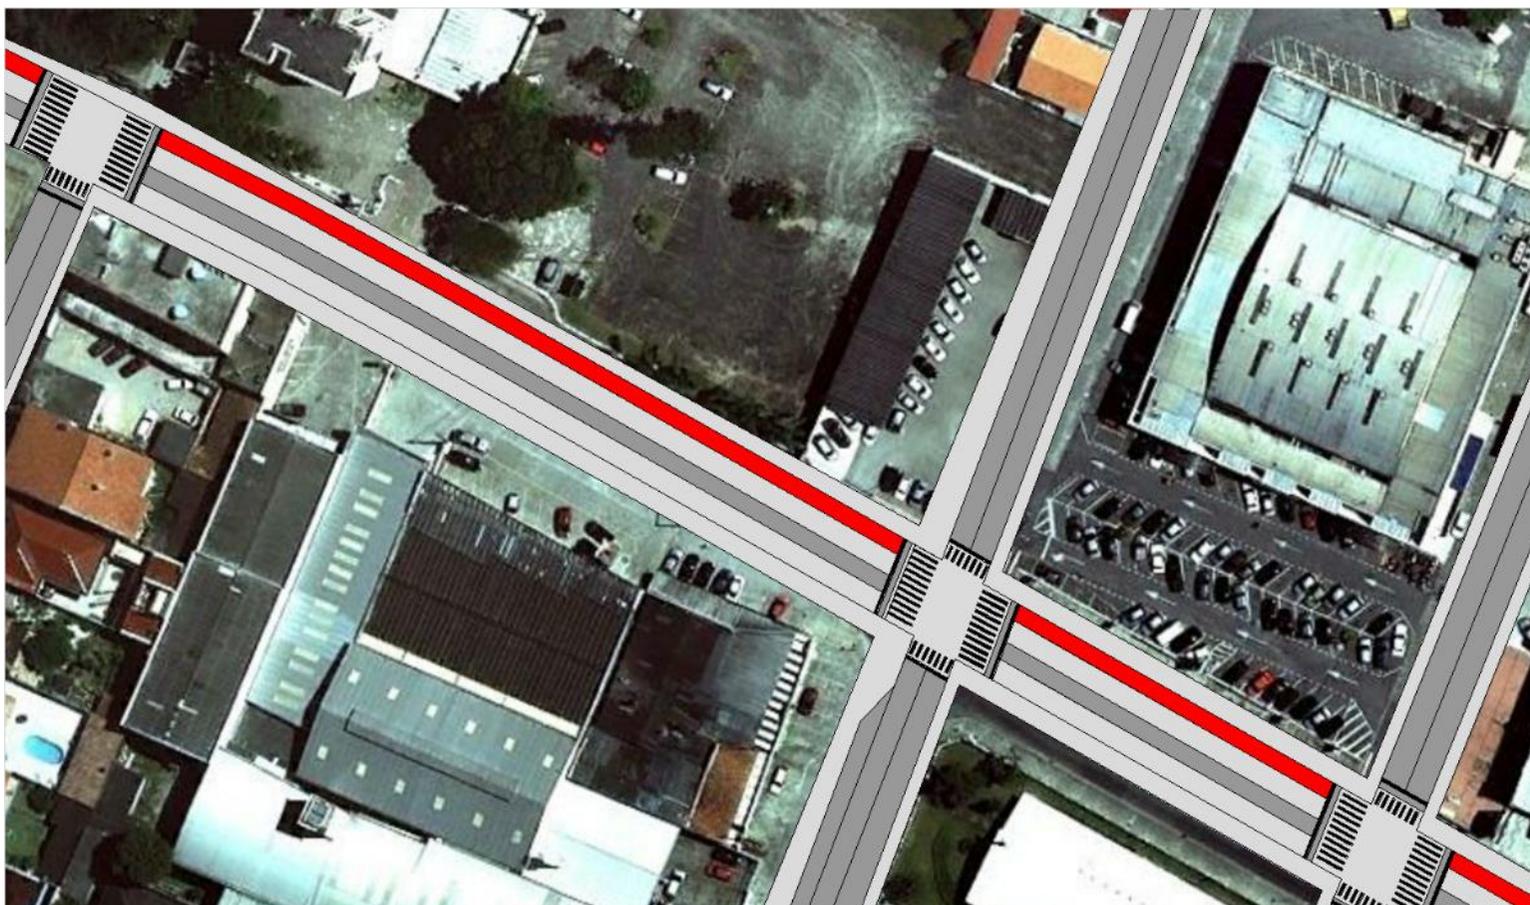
Planta ilustrada com a proposta para a Av. Max Schramm
